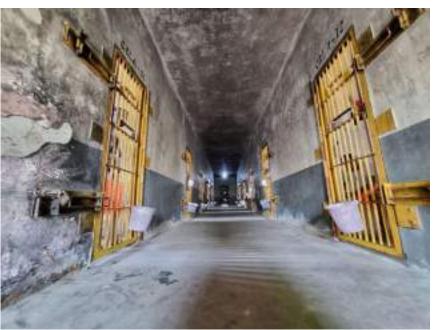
Corredor com estrutura precária e pouca iluminação e ventilação.
